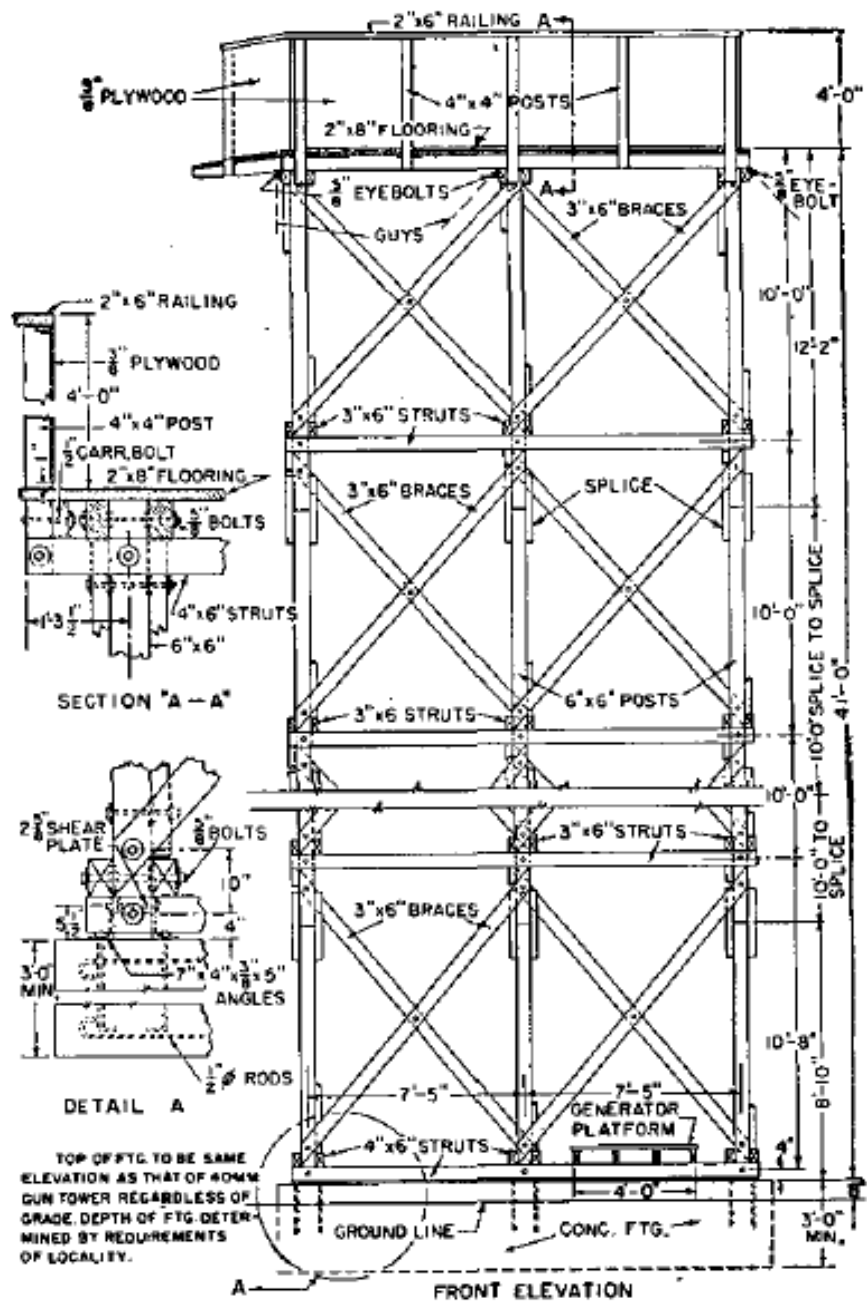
Protiletadlová věž – pohledy, konstrukční detaily schodiště
